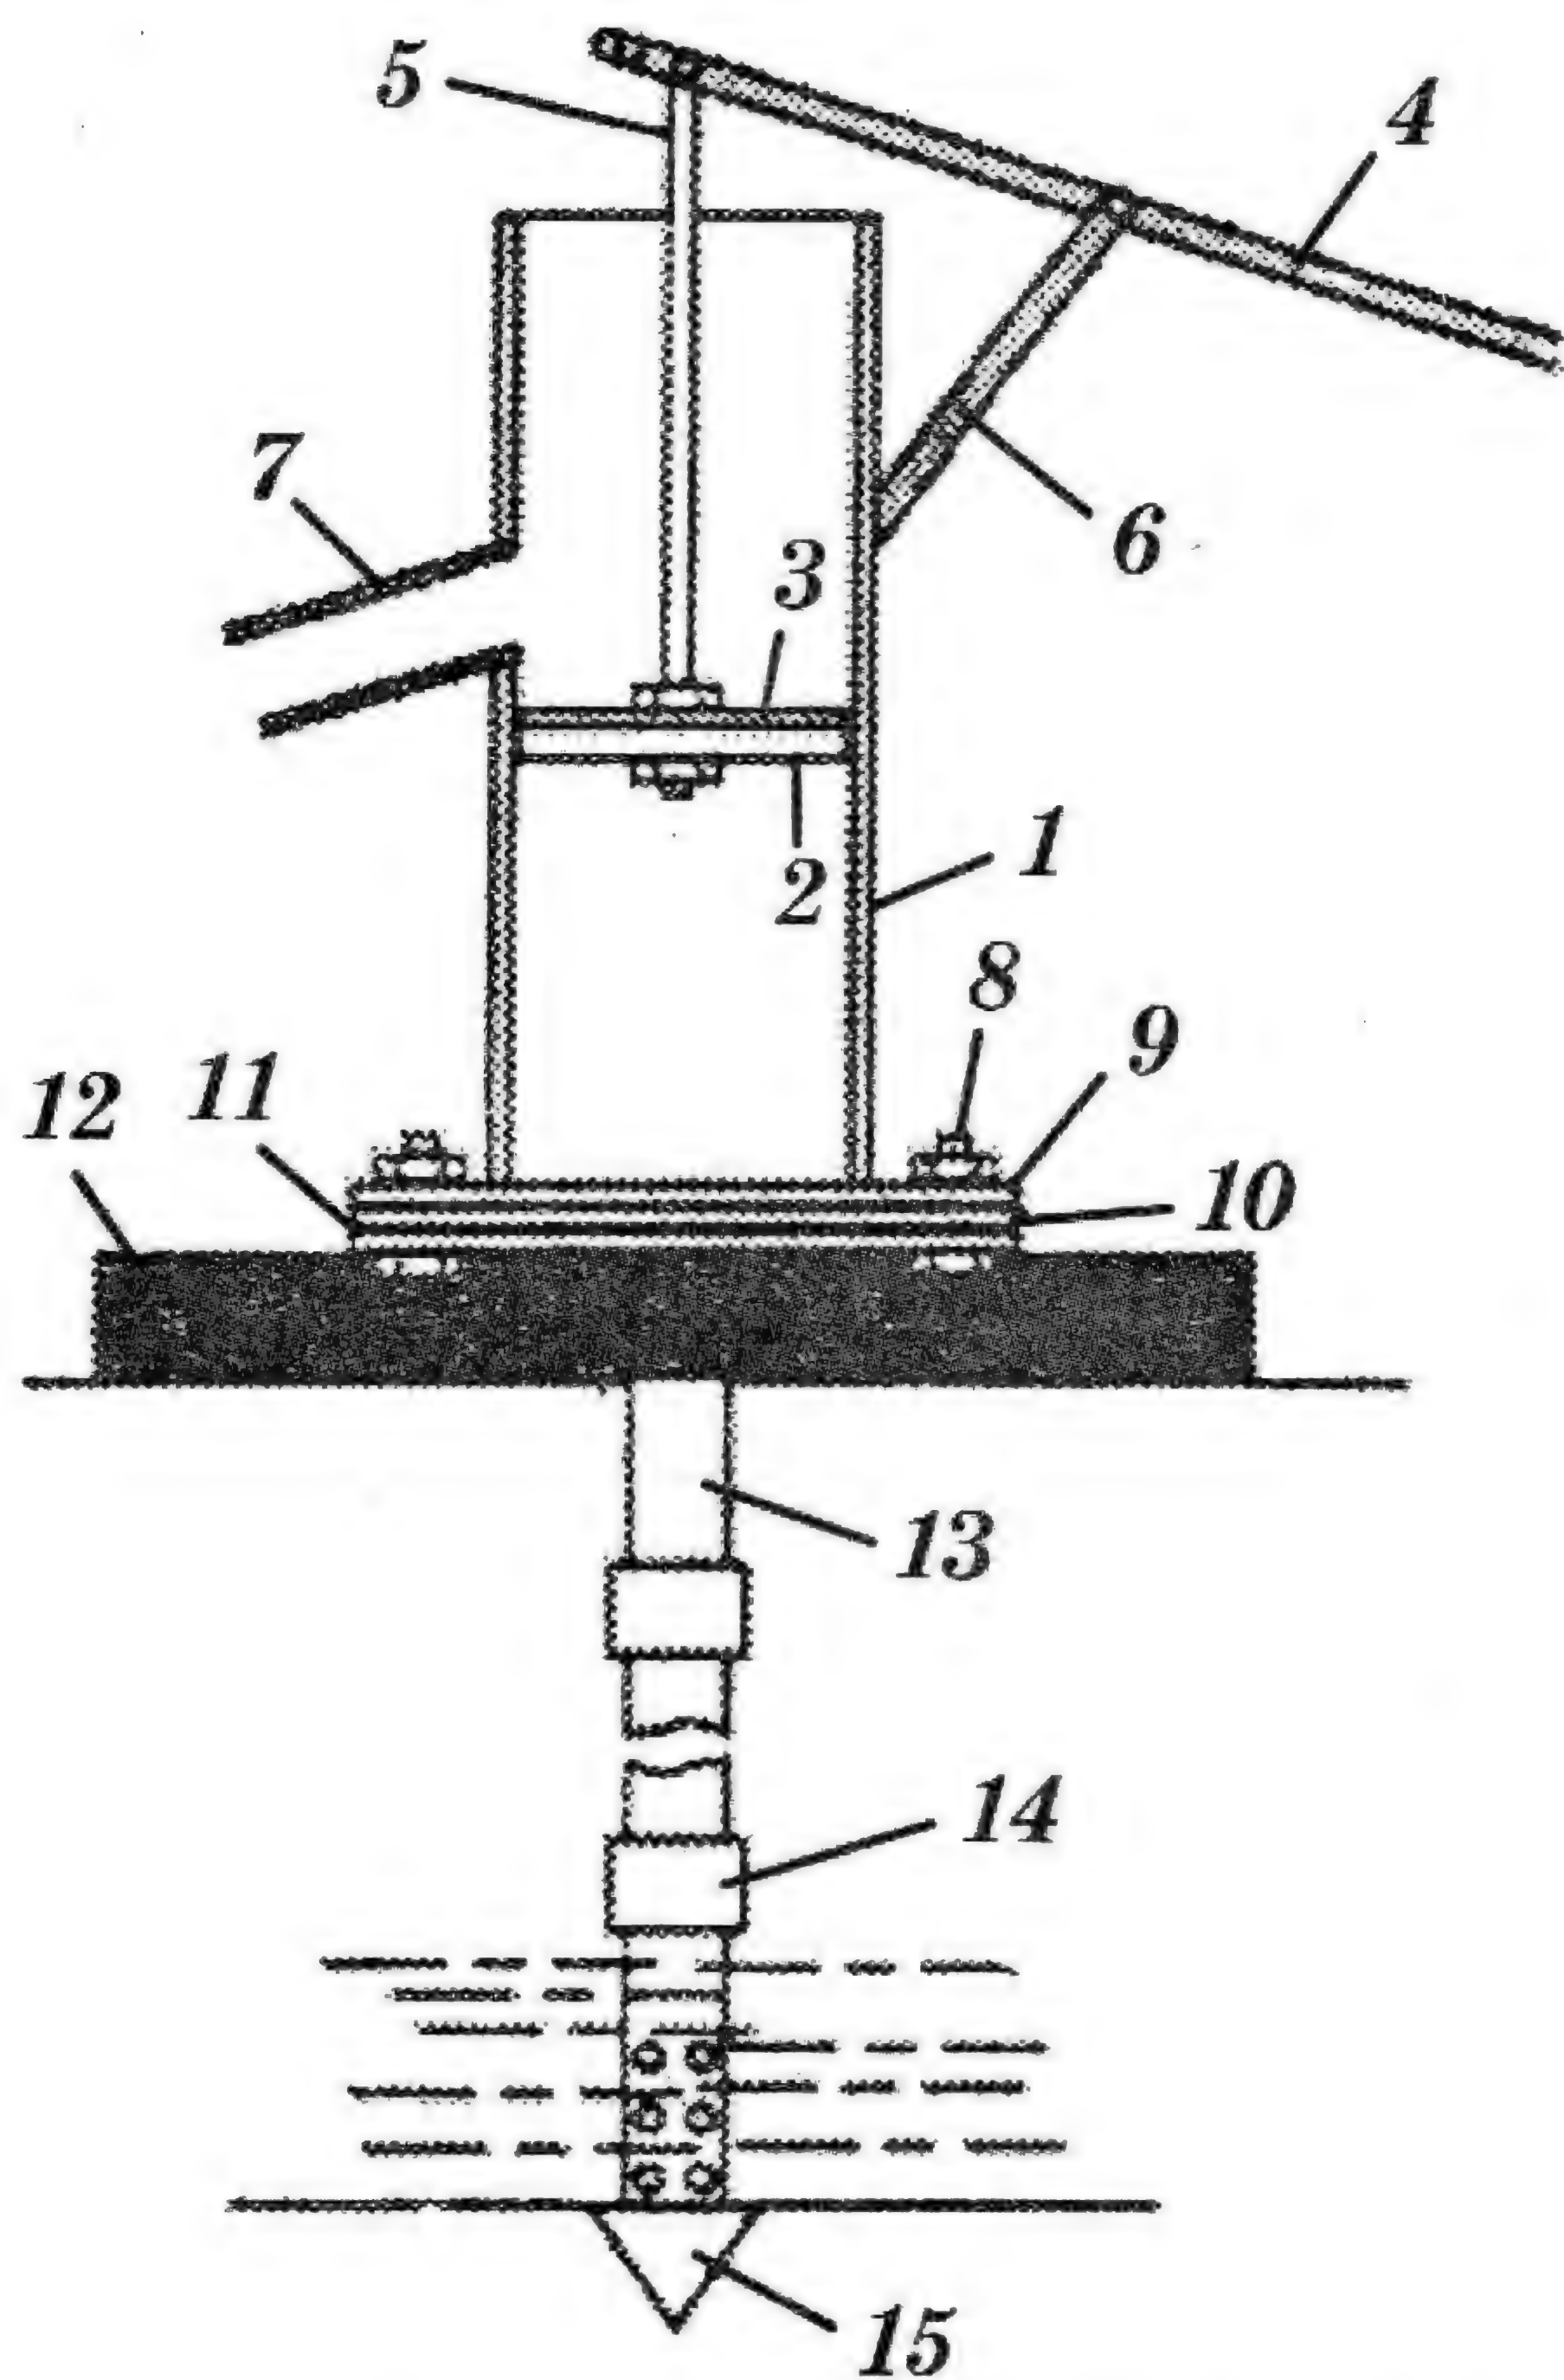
Креслення свердловини у розрізі: 1 – циліндр; 2 – поршень; 3 – гумовий клапан; 4 – важіль; 5 – шток; 6 – опора; 7 – злив; 8 – болт із гайкою; 9 – верхній фланець; 10 – гумова прокладка; 11 – нижній фланець; 12 – дерев'яний брус або бетонна площадка; 13 – хвостовик нижнього фланця; 14 – муфта; 15 – металевий конус.
